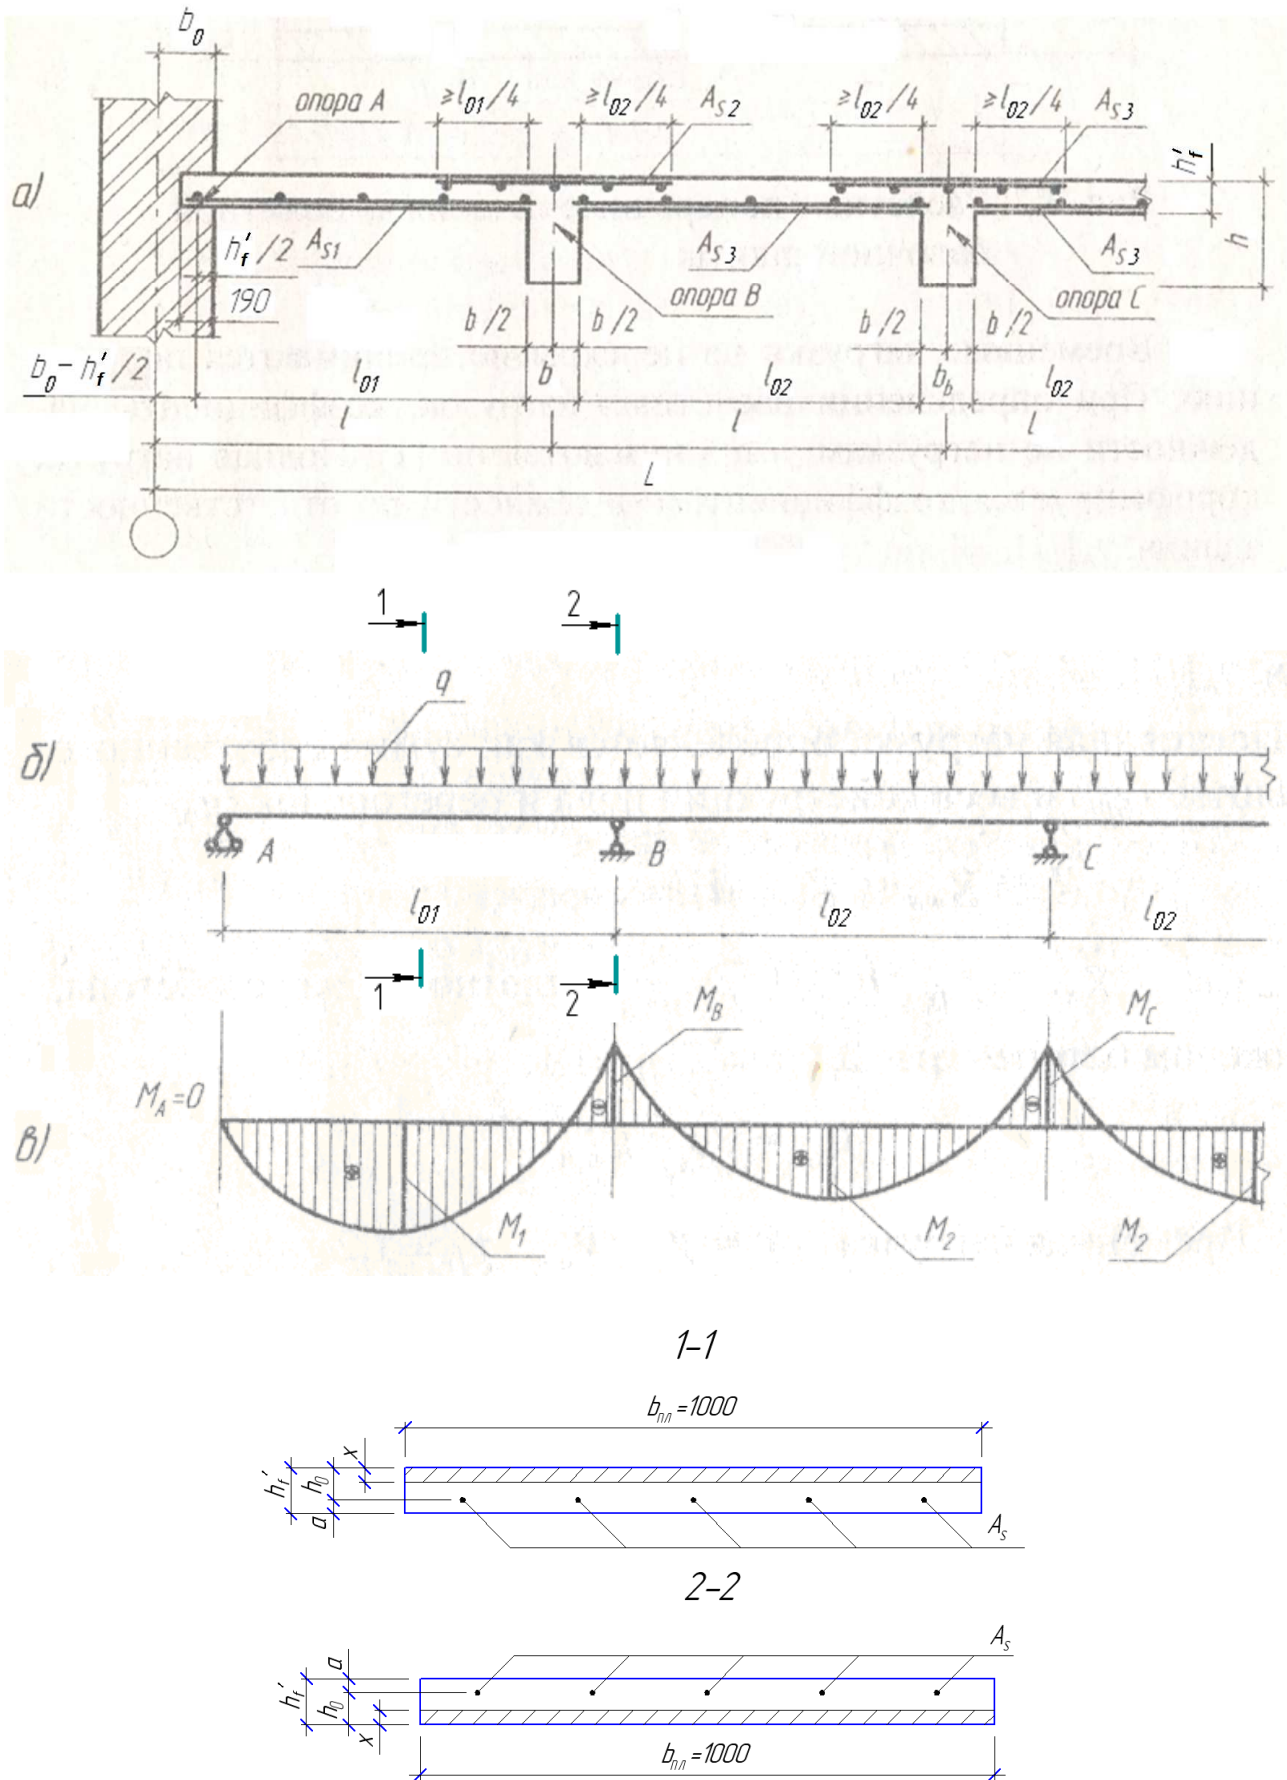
К расчету плиты монолитного ребристого перекрытия: а – расположение арматуры, б – расчетная схема плиты, в – эпюра изгибающих моментов
